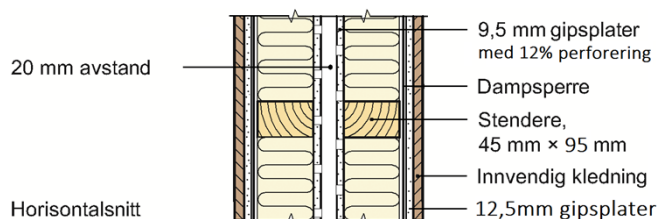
Prinsipiell oppbygning av skillevegger mellom moduler
